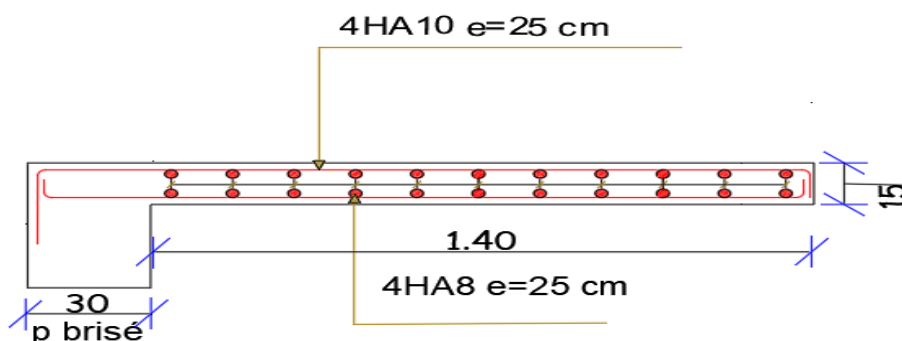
Schéma de ferrailage de console de l'escalier.
